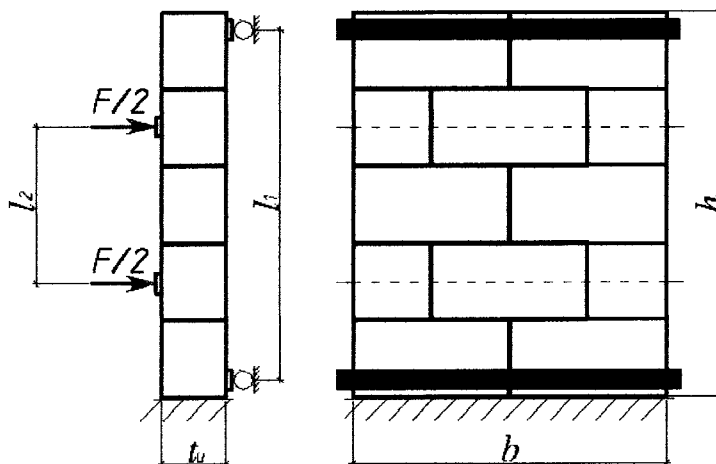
Схема испытаний кладок на изгиб по неперевязанному сечению
